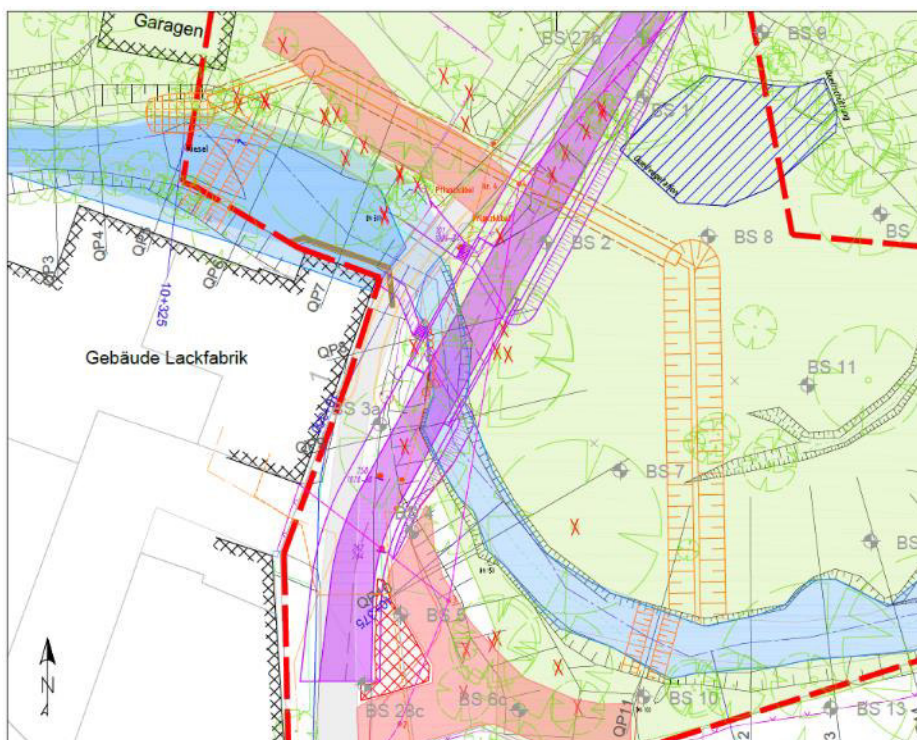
Lageplan Bypass (Auszug BIOTA 2021a)
